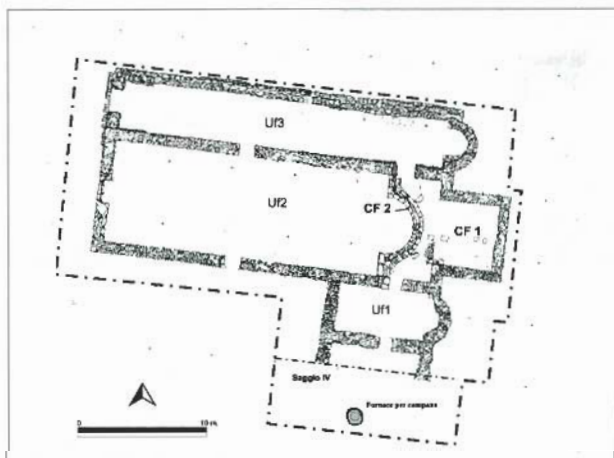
Jure Vetere. Planimetria generale interfase dell'edificio scavato, con ubicazione della fornace per campana.
